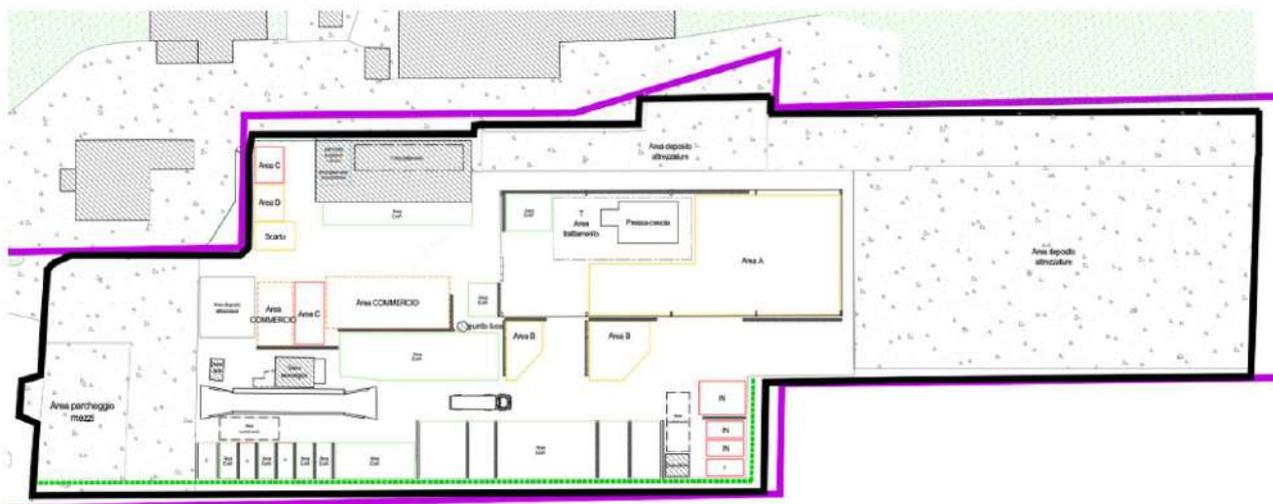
Estratto dell'elaborato grafico A3.8 Tavola n. 5 Layout delle Aree – stato di progetto.
